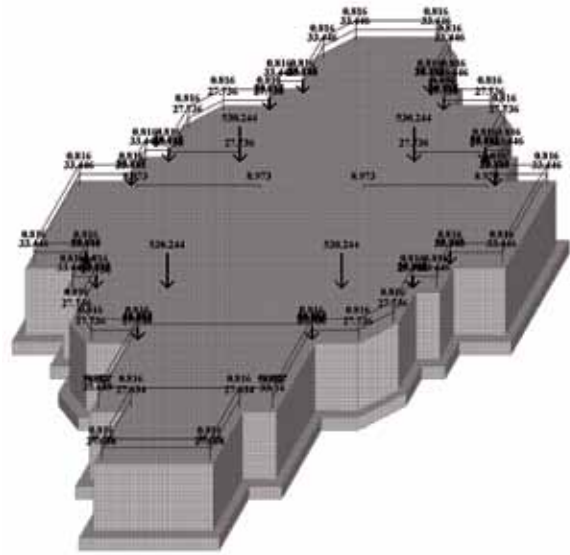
Расчетная схема цокольной части здания на плитном фундаменте
